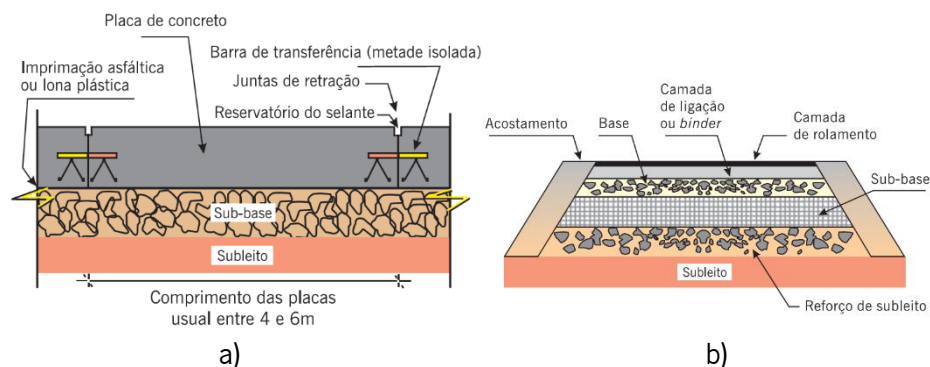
Tipos de pavimentos rodoviários: a) pavimento rígido; b) pavimento flexível (Bernucci *et al.*, 2008)
